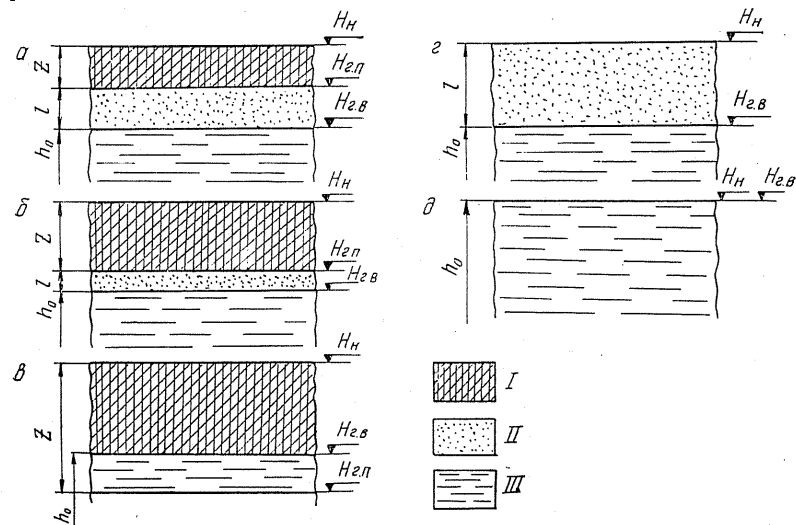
Расчетные схемы для определения высоты насыпи земляного полотна над УГВ: I — мерзлый грунт; II — влажный; III — уровень грунтовых вод
